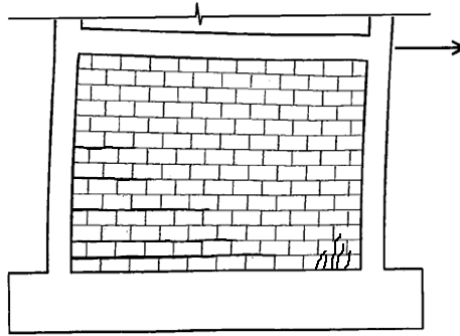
Agrietamiento a flexión en el panel de mampostería
